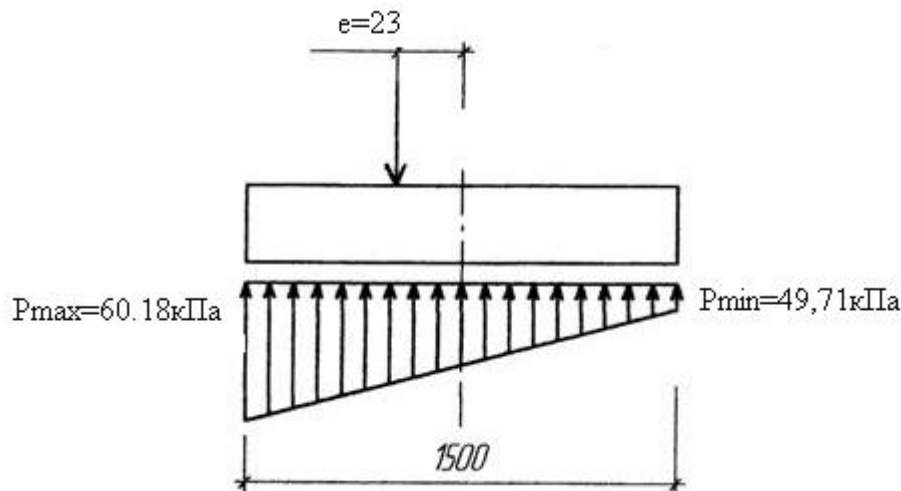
Еюра тиску під подошвою фундаменту під колону
